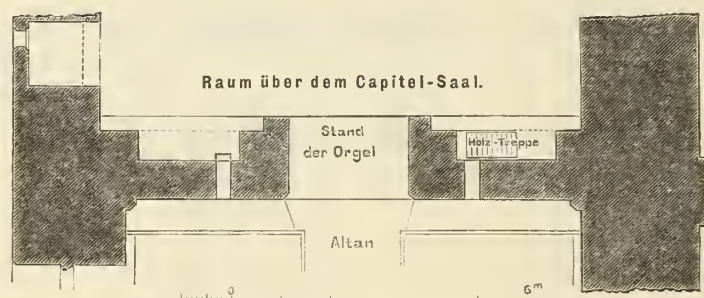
Westwand der Kirche. — Oberer Grundriss.
